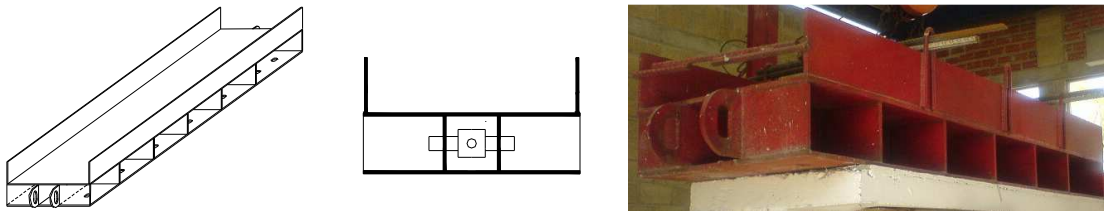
Viga de acero para la aplicación de la carga vertical y lateral.
